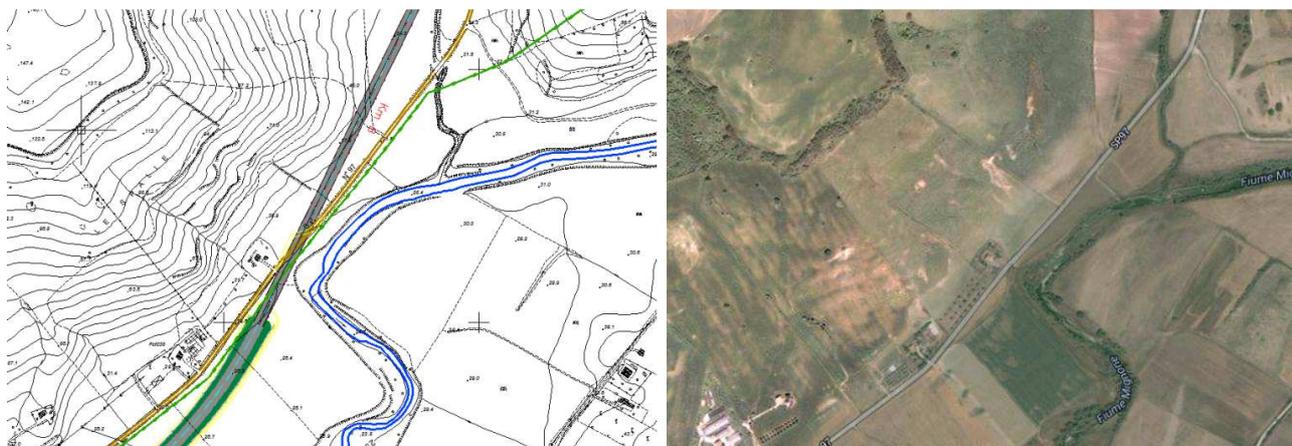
Planimetria di progetto km 8+500 (sn) e ortofoto stato attuale (ds).
